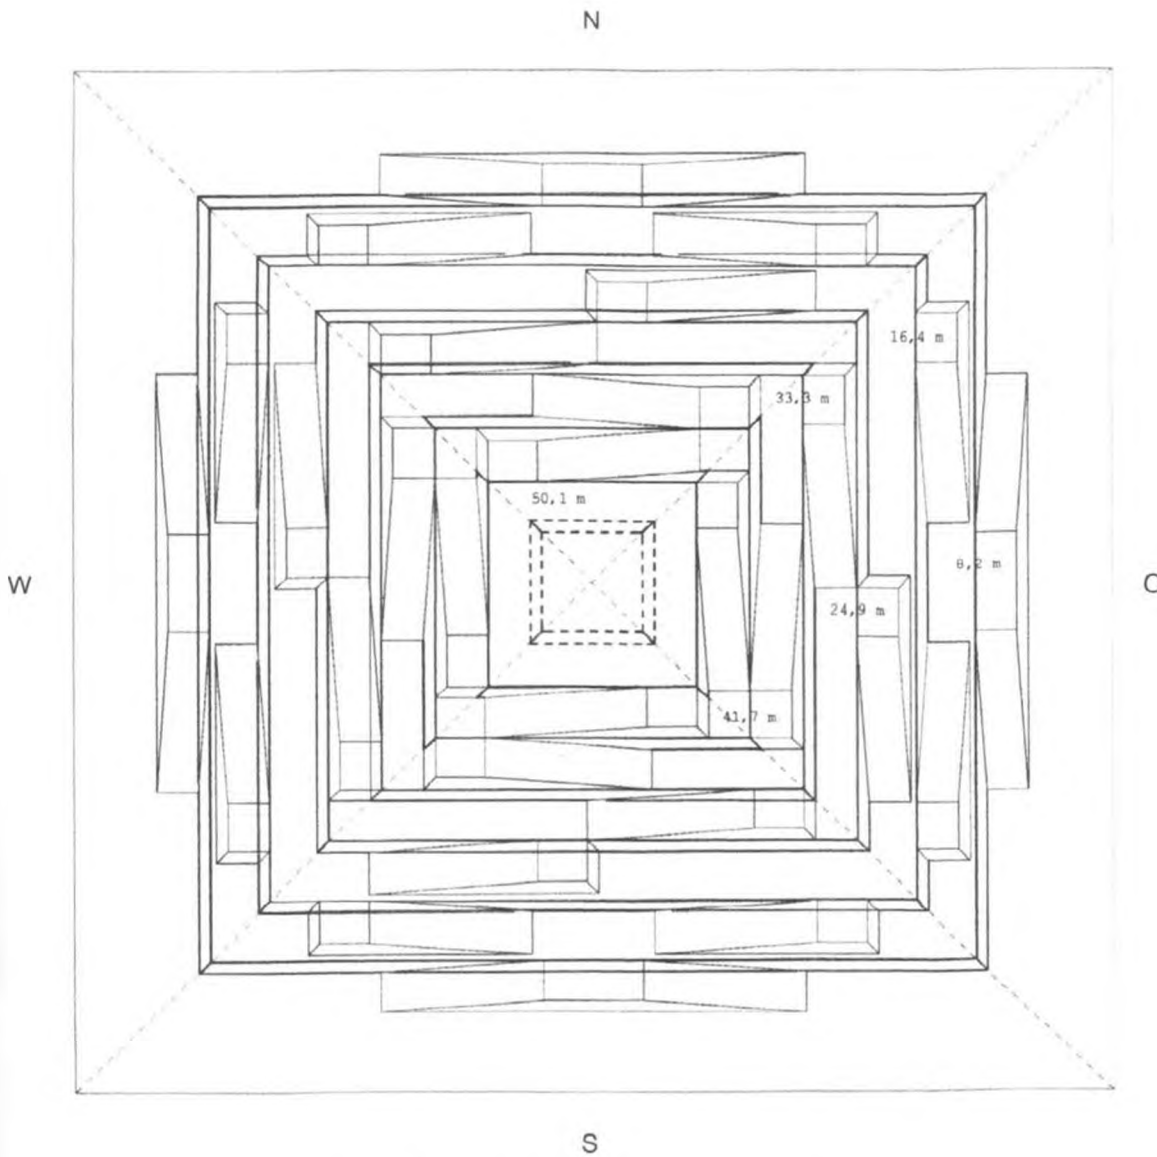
Aufsicht auf alle Rampen des Kernmauerwerks<sup>32</sup>
